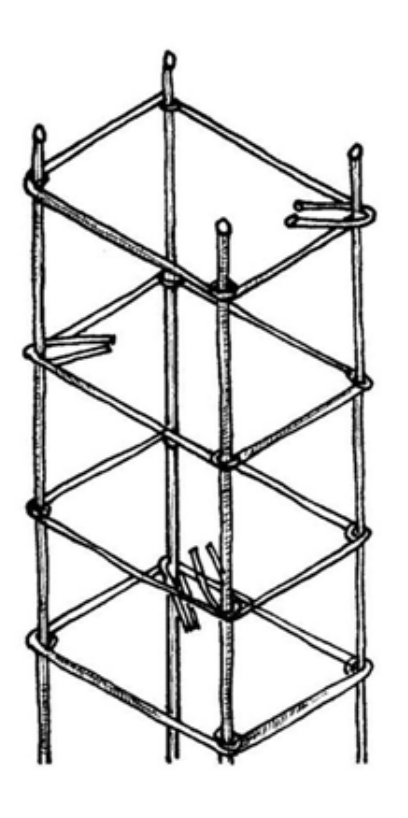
Alternancia en la colocación de los ganchos de los estribos (Totten, 2010)
